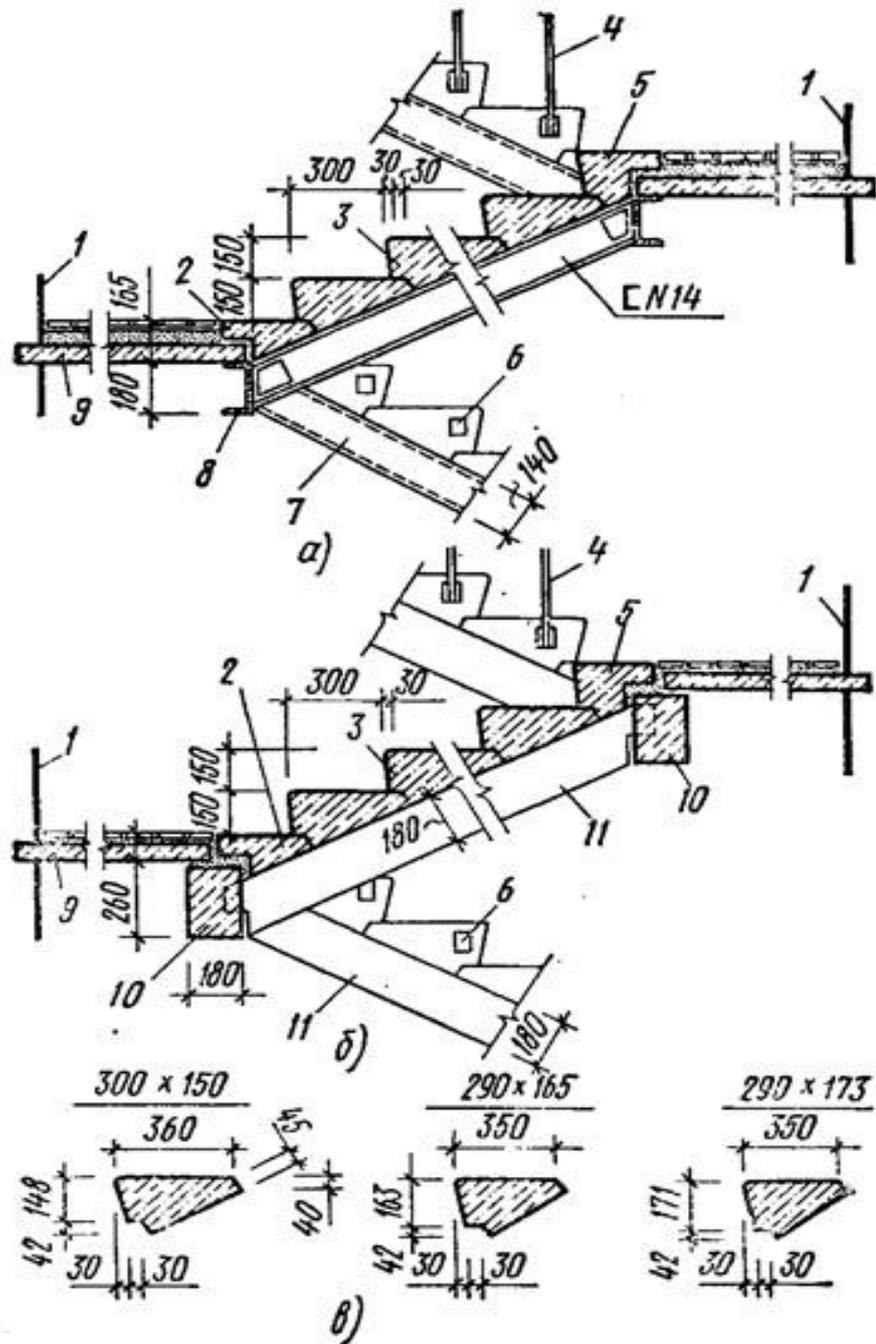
Лестницы из мелкоразмерных элементов с железобетонными ступенями и металлическими косоурами: 1 – стена лестничной клетки; 2 – нижняя фризная ступень; 3 – рядовая ступень; 4 – стойка ограждения; 5 – верхняя фризная ступень; 6 – закладная деталь; 7 – металлический косоур; 8 – металлическая площадочная балка; 9 – площадочная железобетонная плита; 10 – площадочная железобетонная балка; 11 – железобетонный косоур а и б – по металлическим и сборным железобетонным косоурам; в – типы ступеней для разных уклонов;
